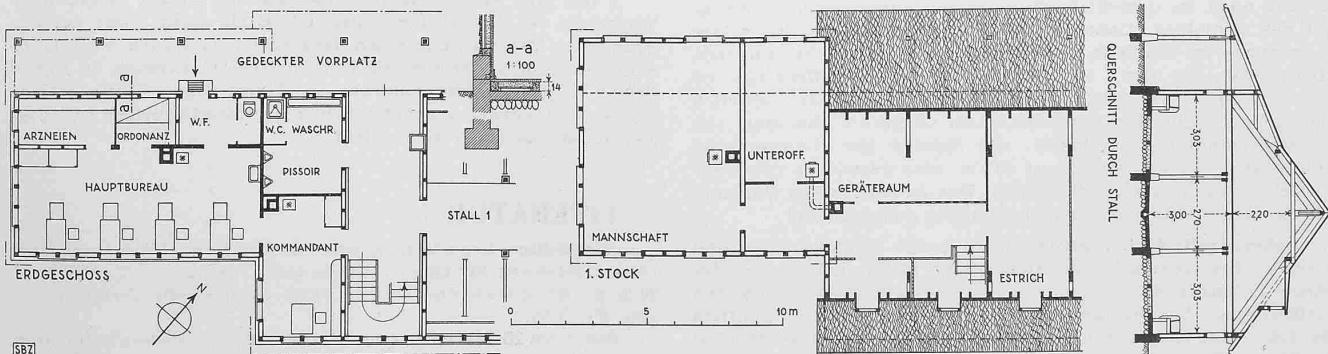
Grundrisse vom Kopfbau-Erdgeschoss und Obergeschoss, rechts Schnitt der Stallungen. — Masstab 1:250
